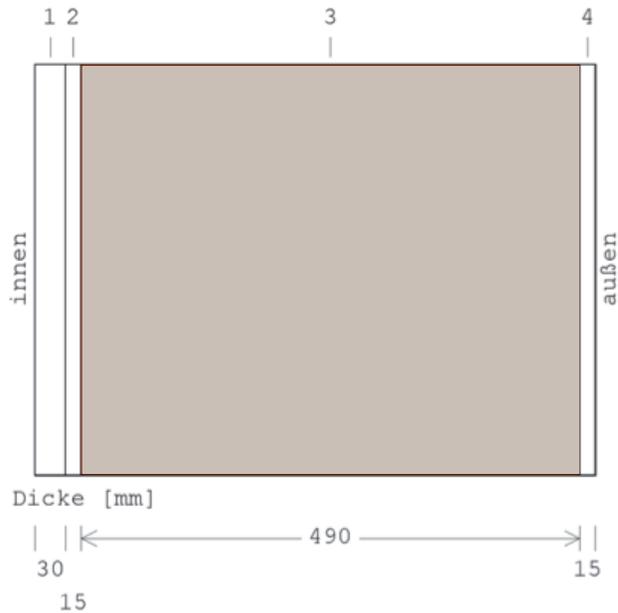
Aufbau oberste Geschossdecke ohne Dämmung / Schema und Tabelle
